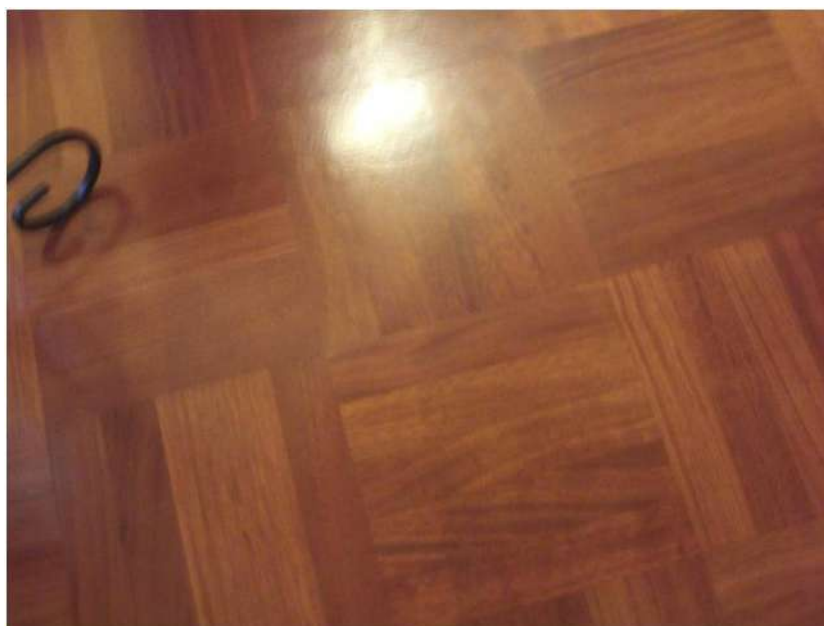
Foto interno : pavimento parquet camere da letto e disimpegno – sub 2 piano 2°
